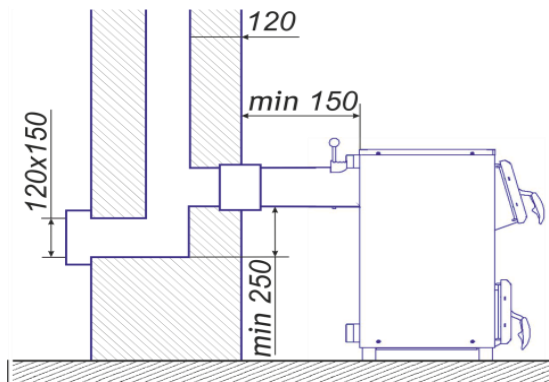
Устройство сажеборника и ревизионного окна при расположении дымохода в шахте (вид сбоку)
